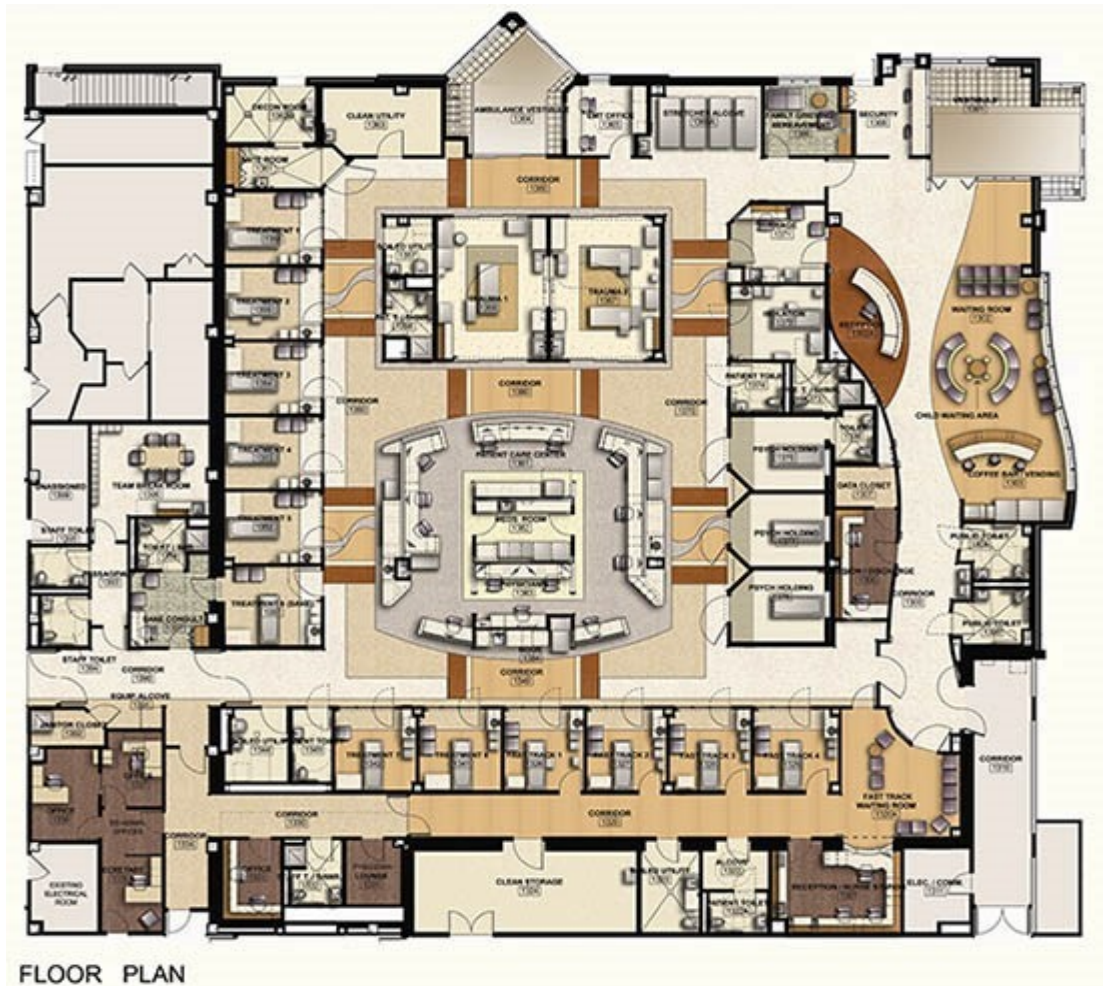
Exemplo de planta baixa de sala de emergência com disposição circular.
